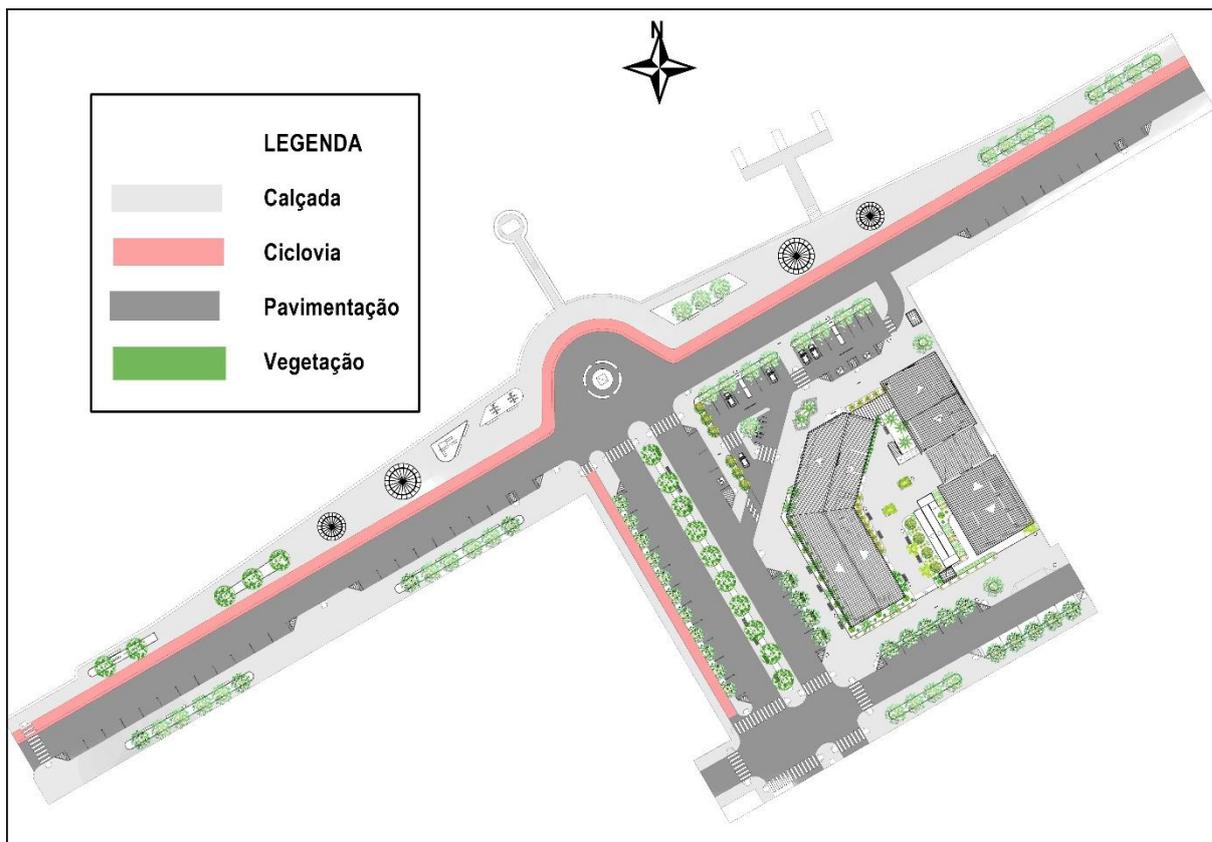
Proposta esquemática do eixo de intervenção Urbana. Fonte: Bandeira, 2016.
